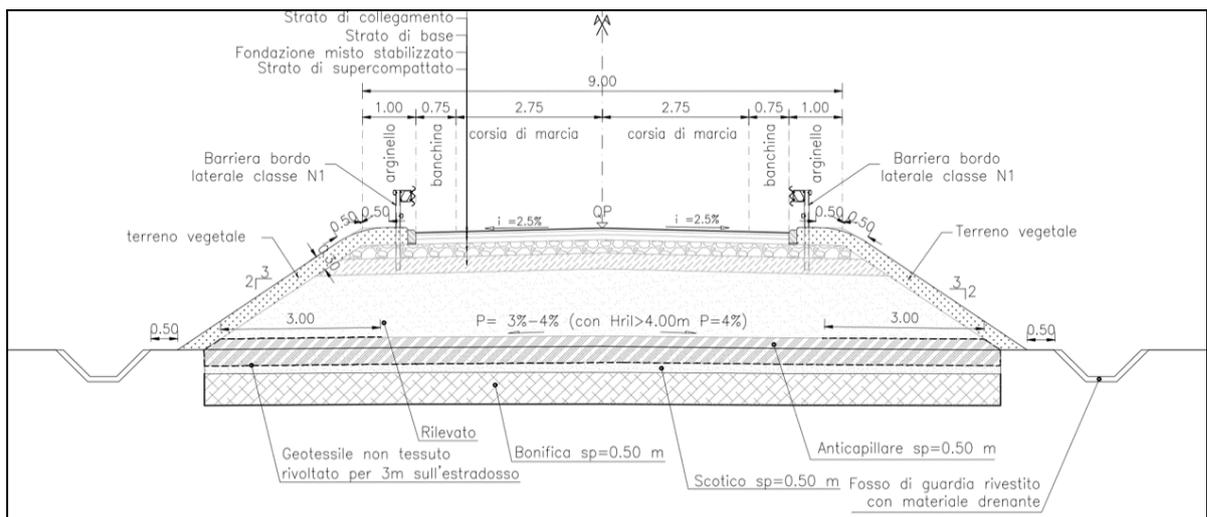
NV_ASSE 2: Ponte stradale sul Torrente Evigno - Sezione tipo in rilevato in prossimità dell'intersezione con via Burche.
